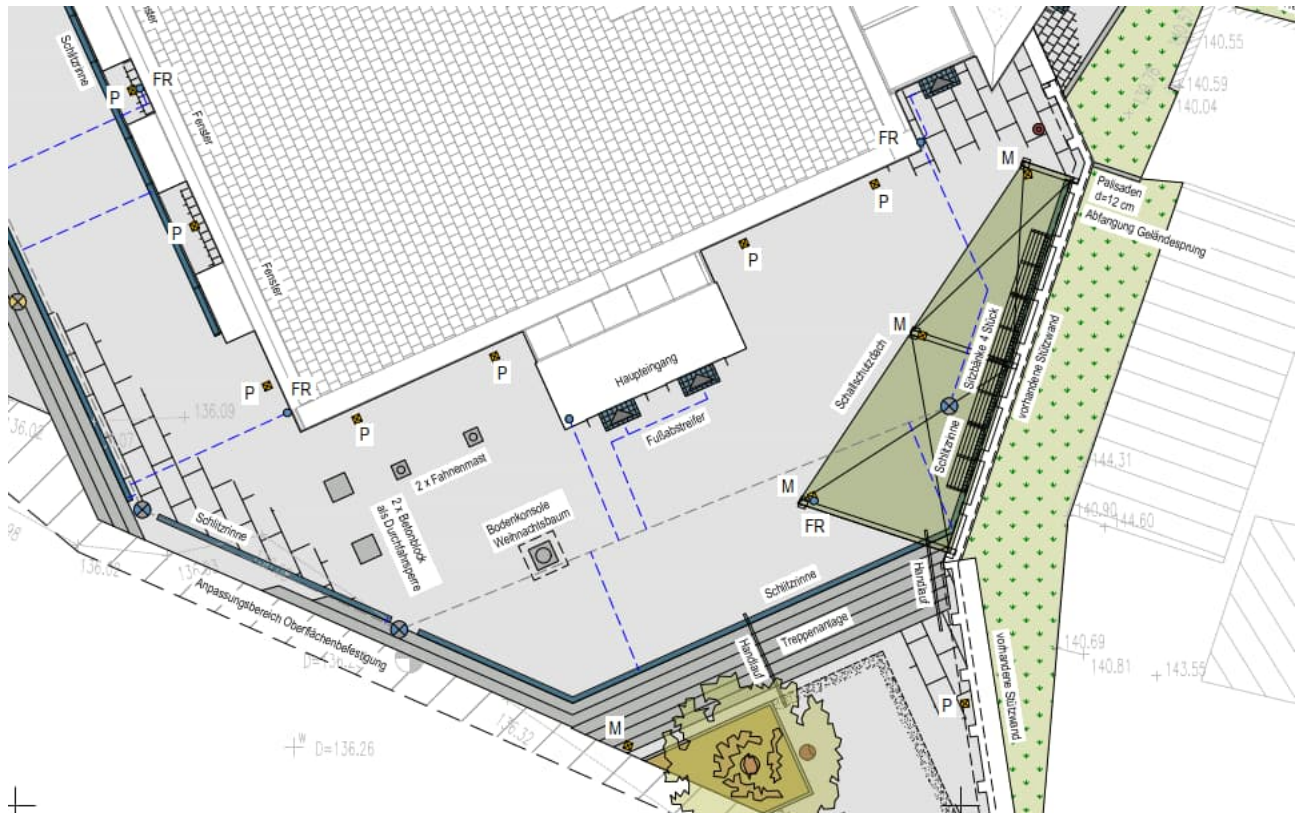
Lageplanausschnitt südlicher Bereich Volkshaus Grotzsch mit Schallschutzdach
